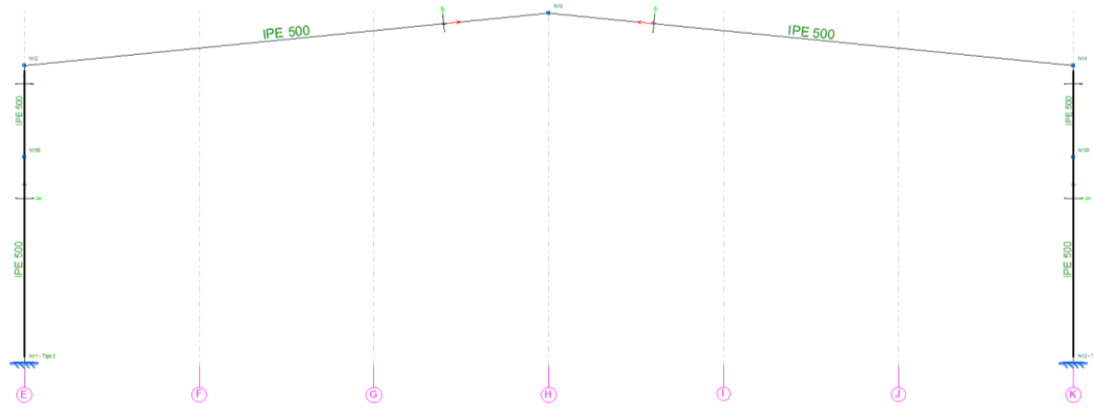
Pórtico interior de nave principal con detalle de perfiles
